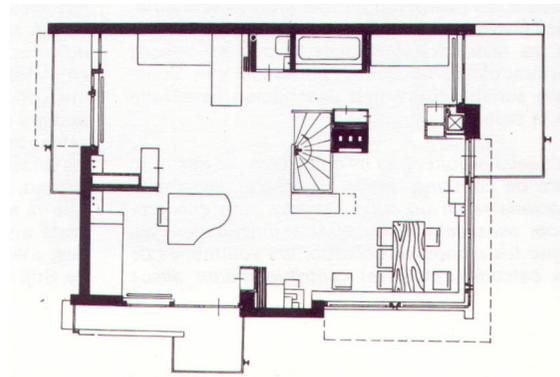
Schröder Haus - Grundriss - Wände Offen
